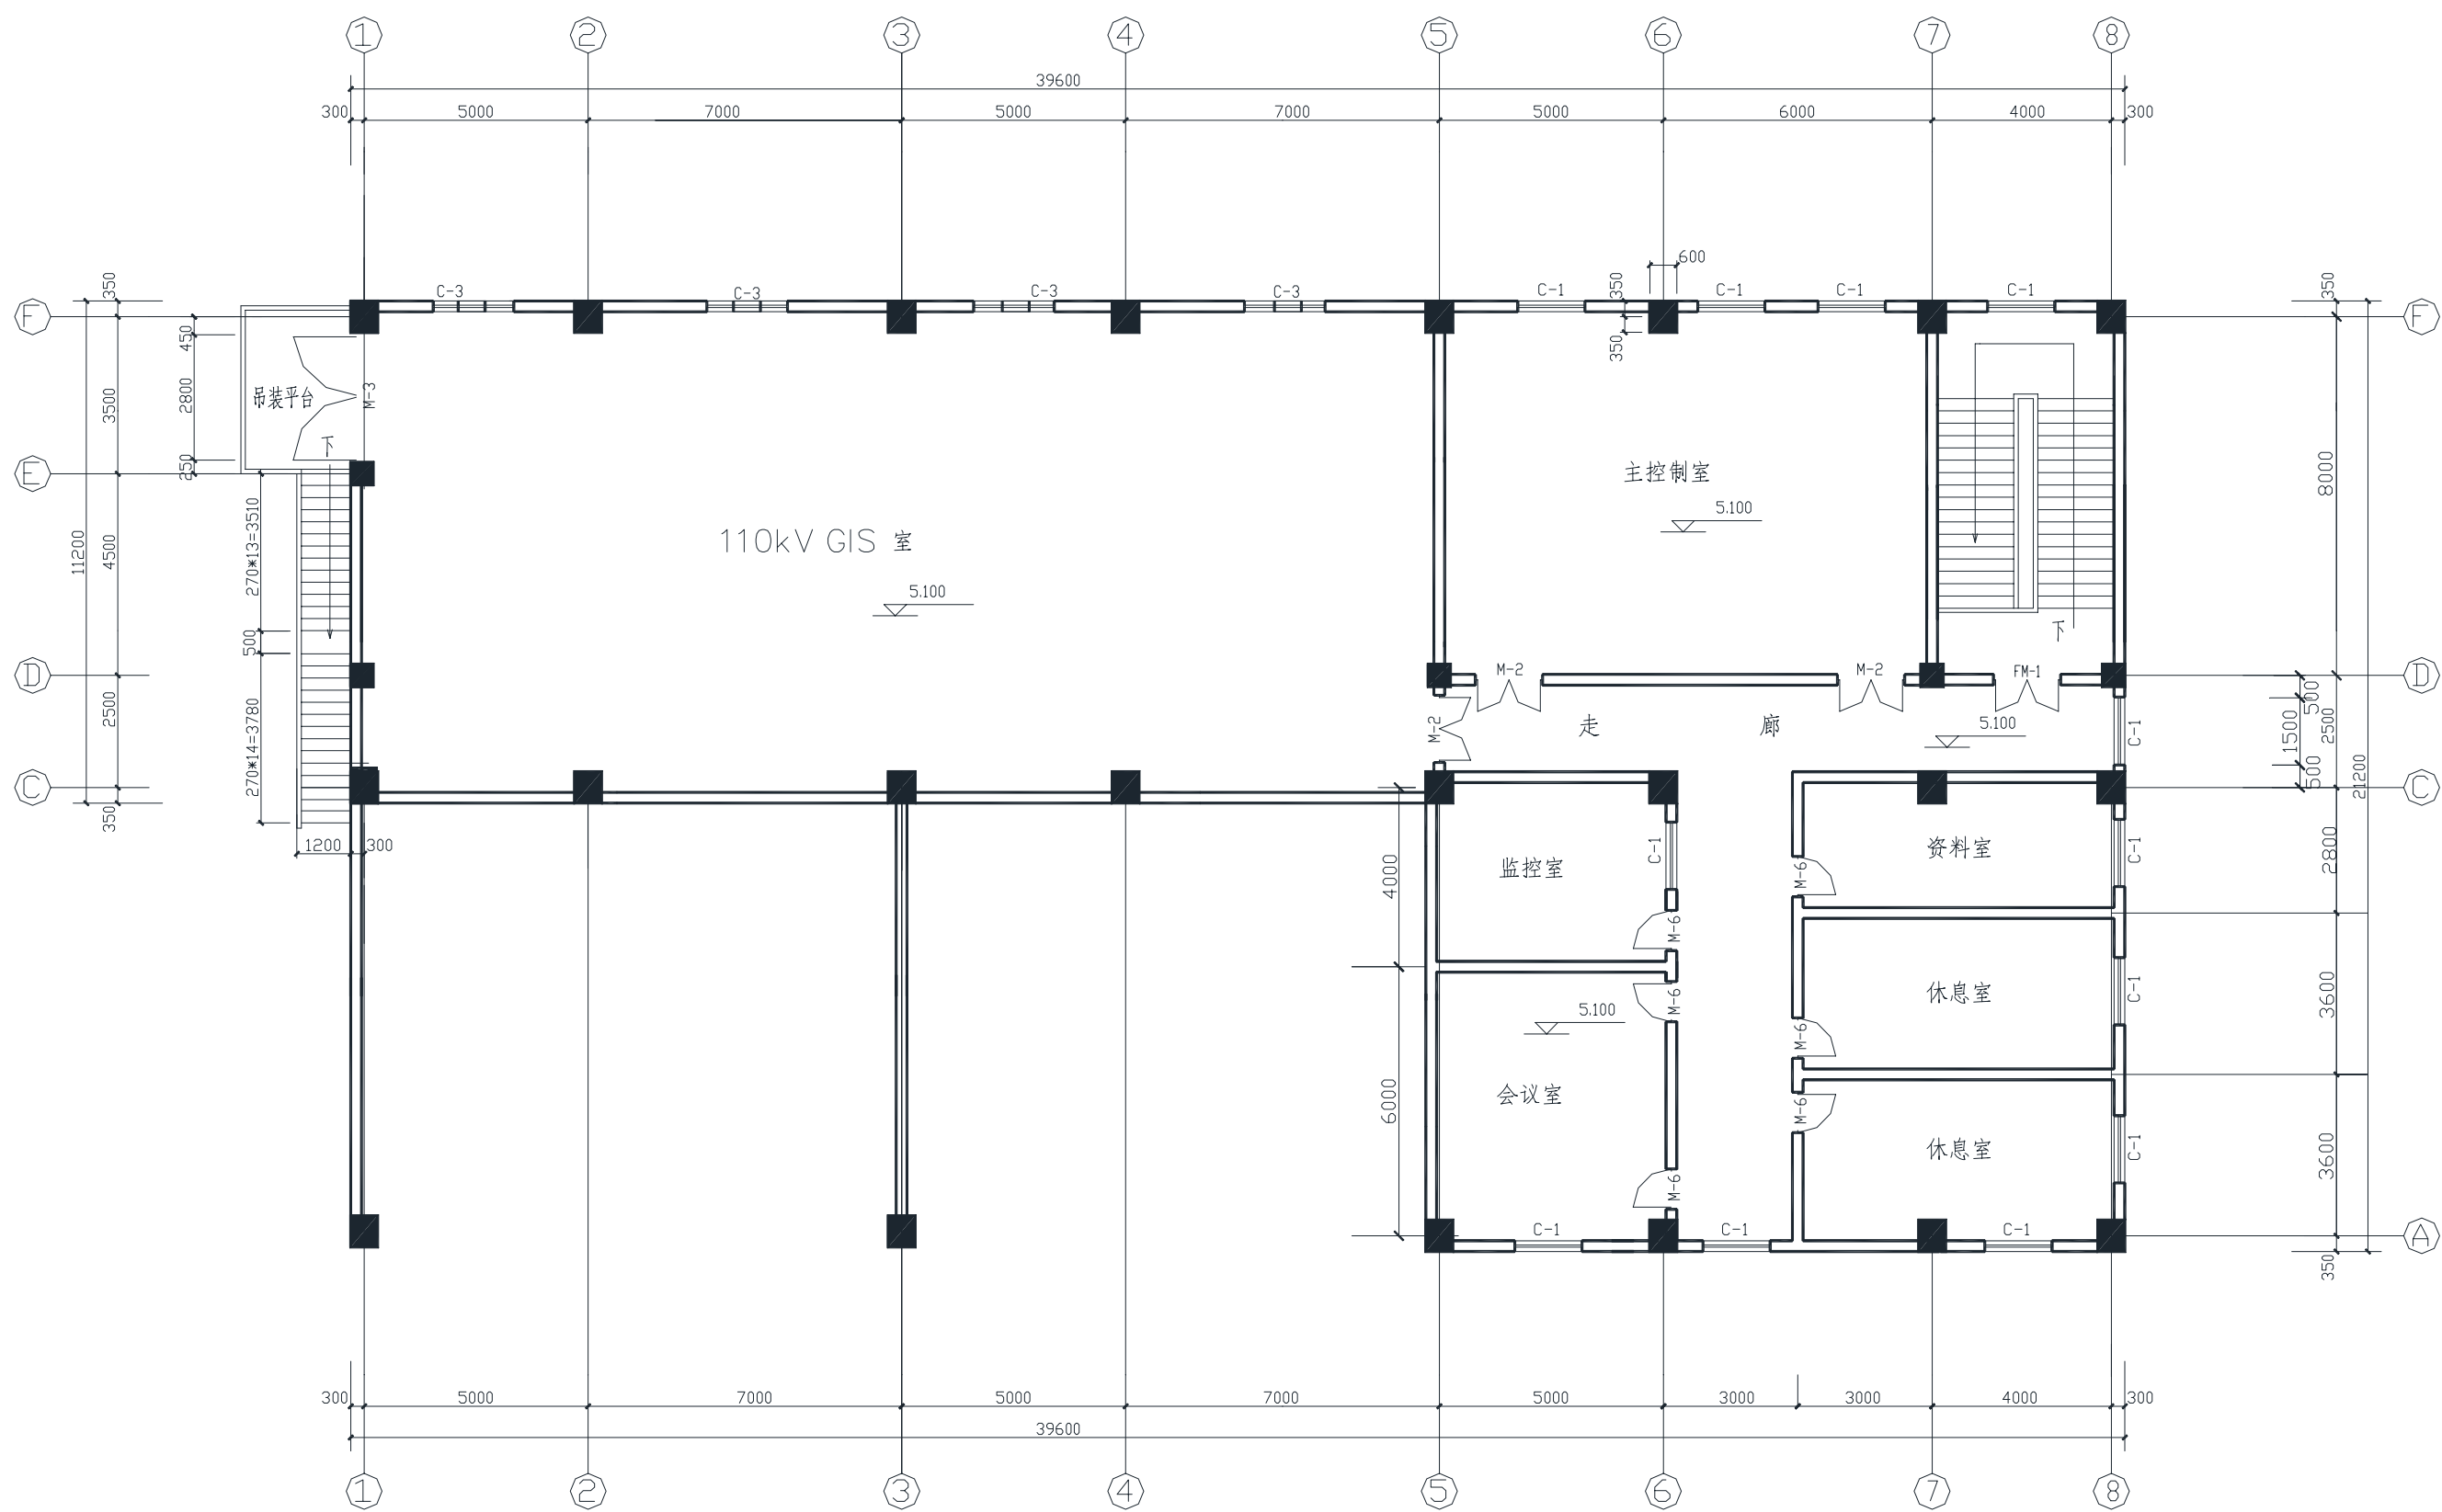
综合配电室二层平面布置图 (A3-1-06)
